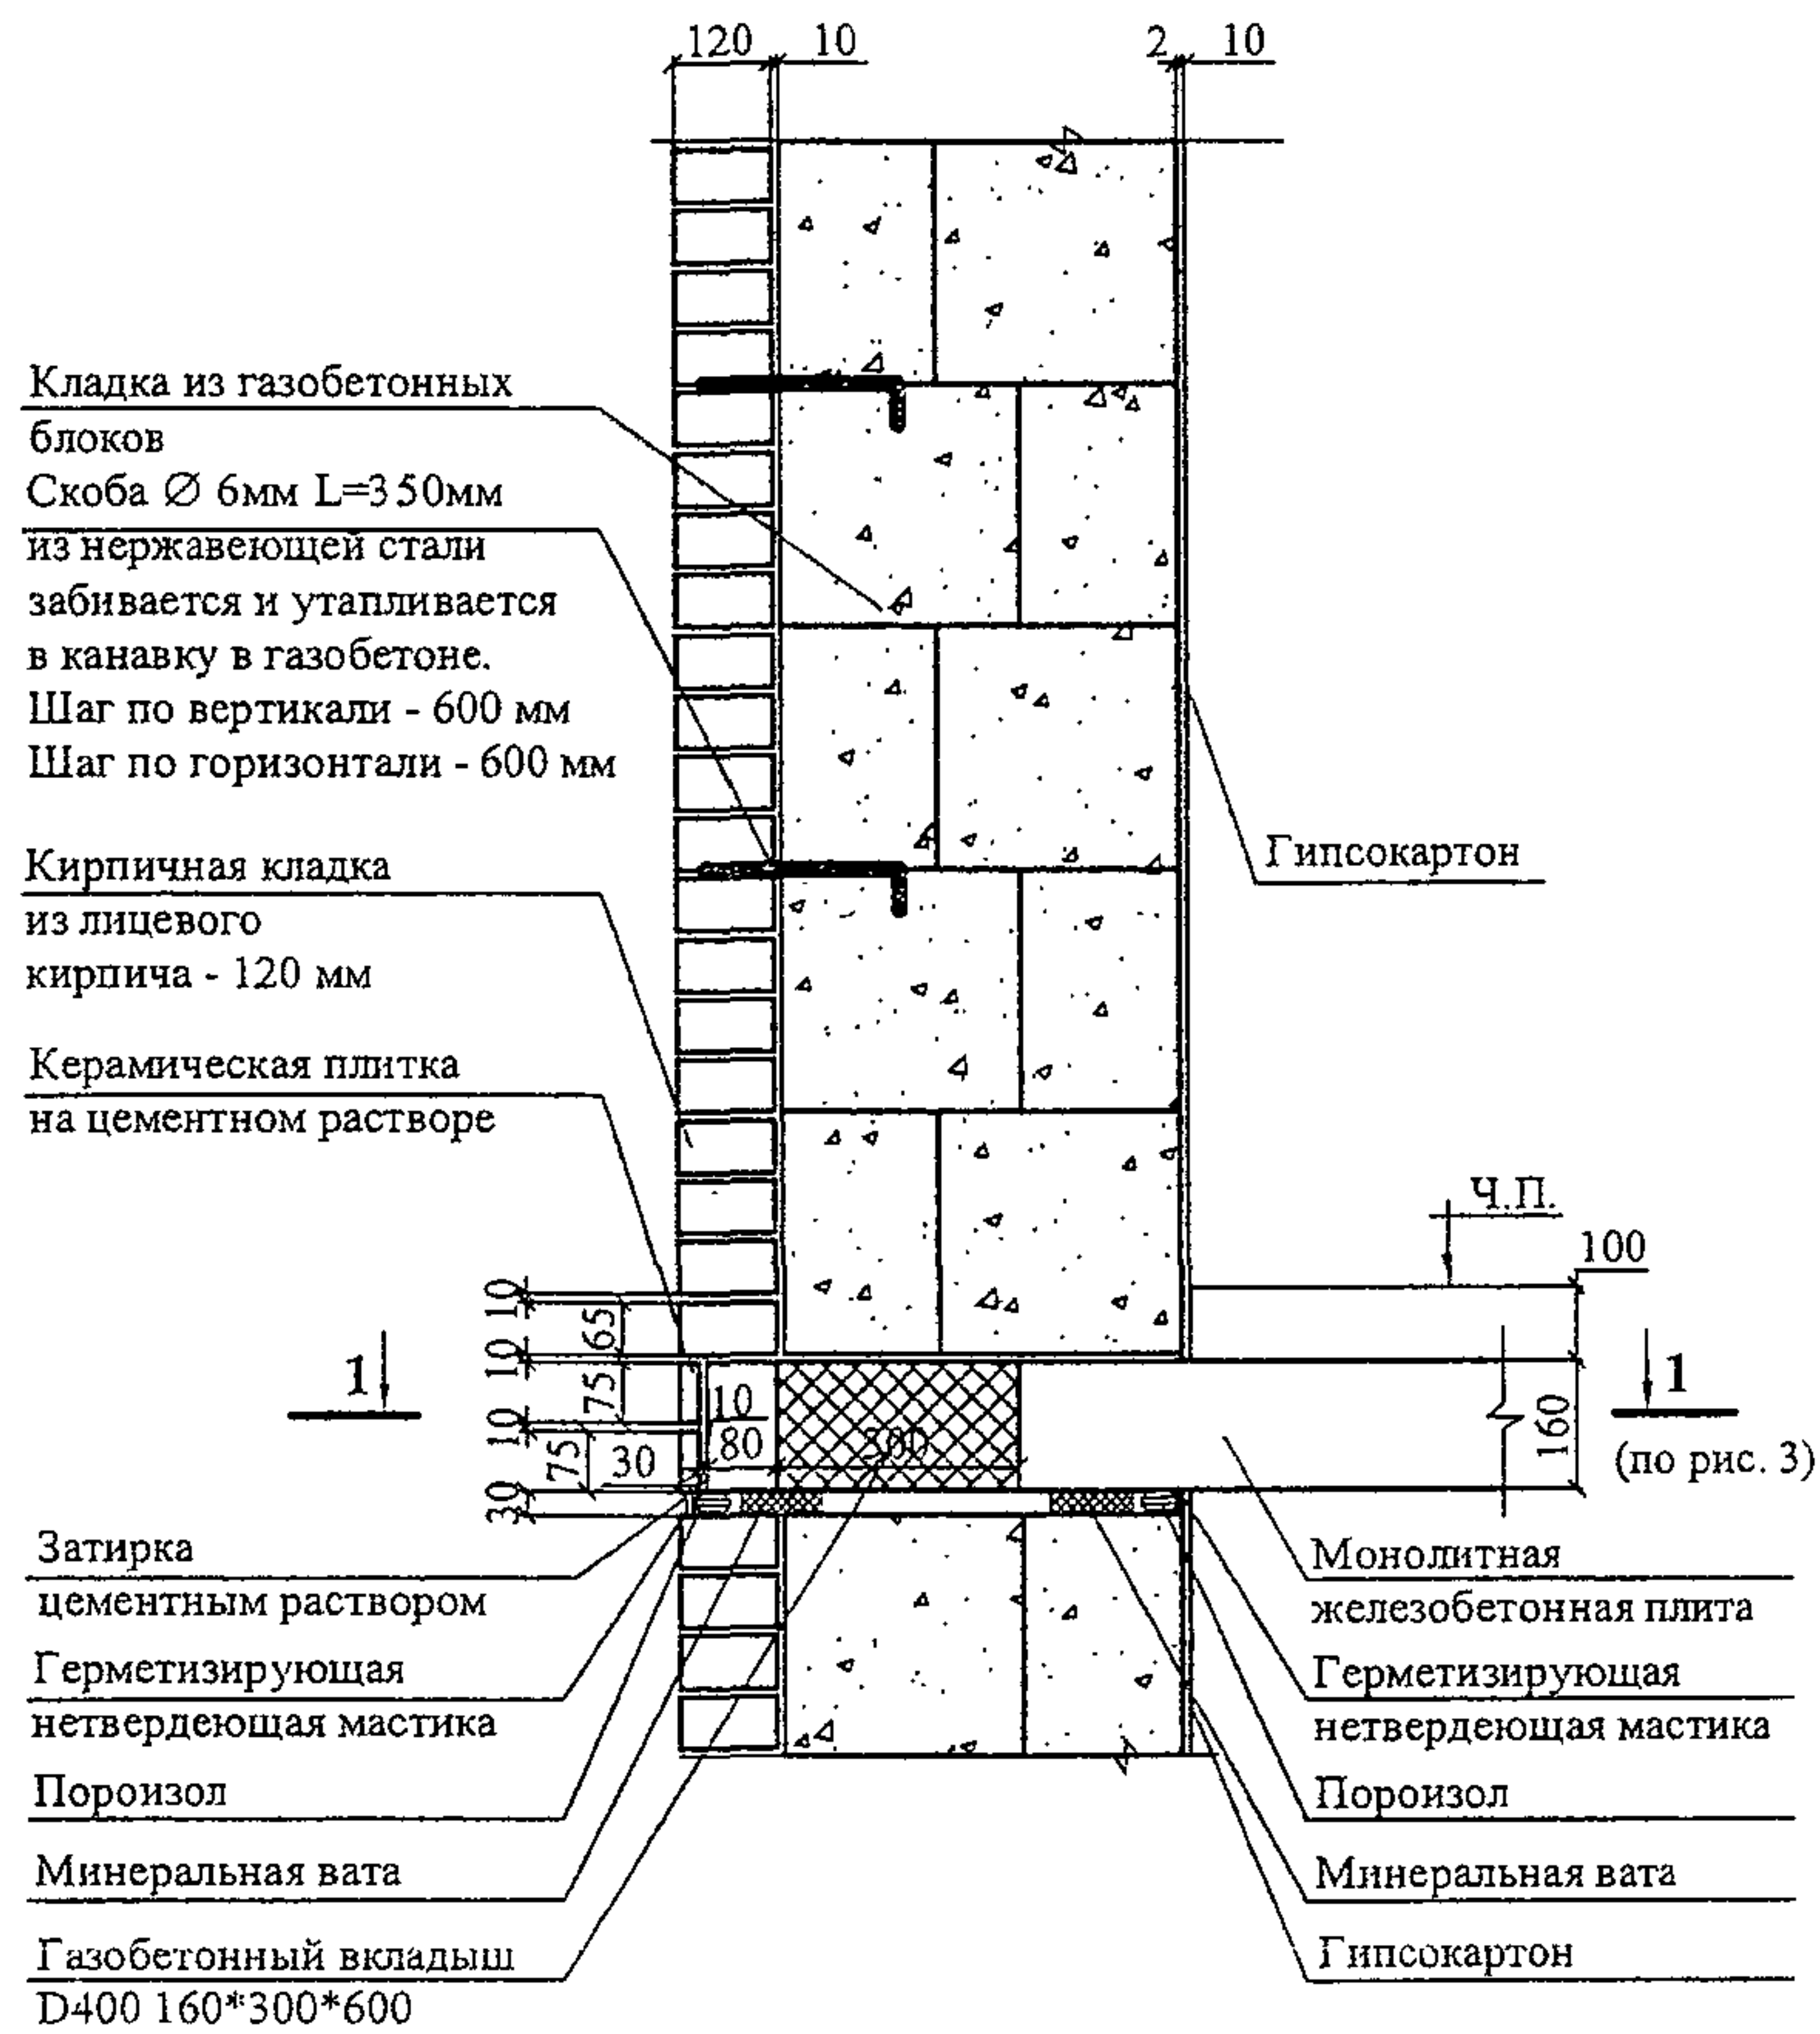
Навесная стена из кирпича и газобетонных блоков
